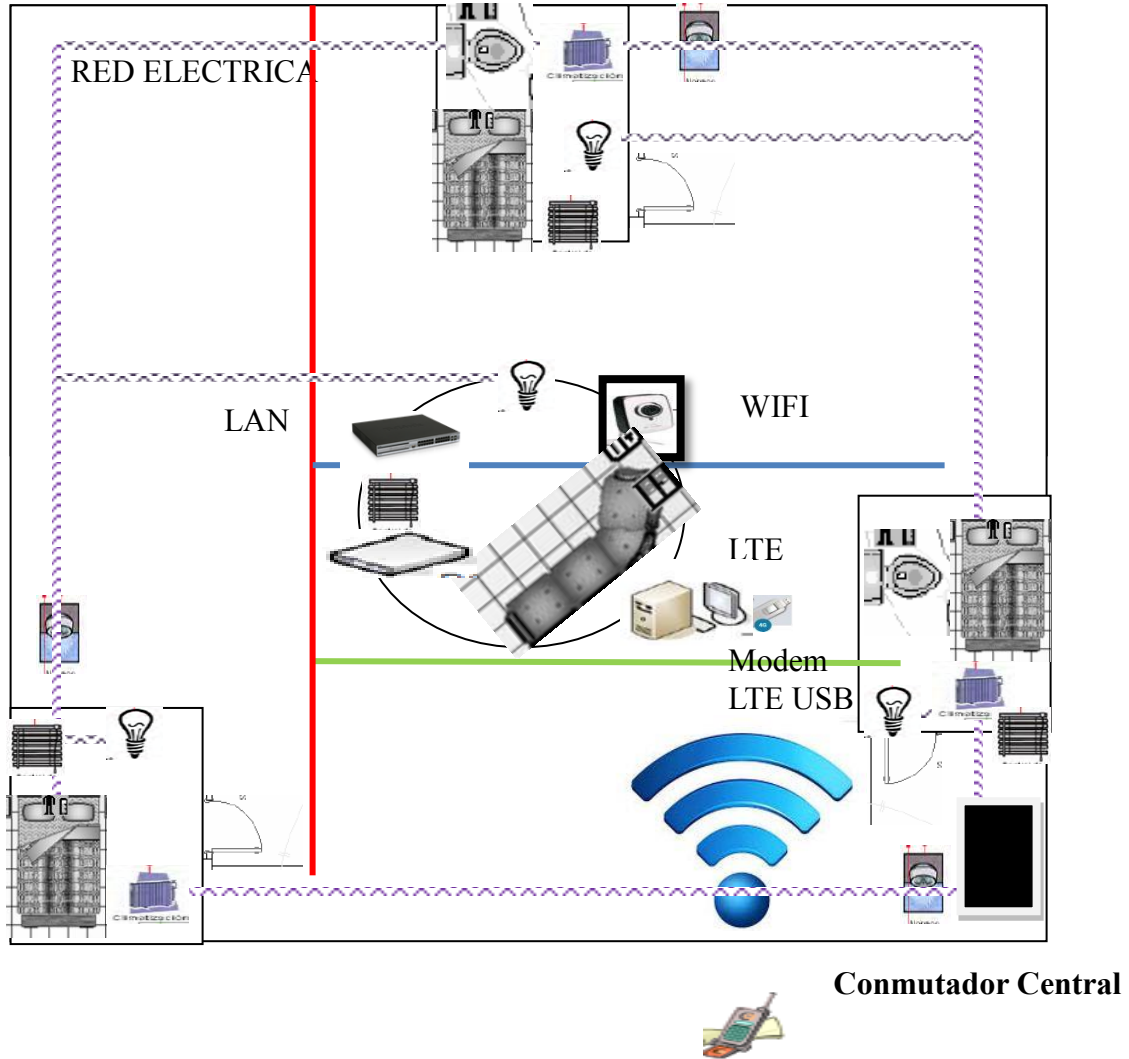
Instalación de la Red Domótica y Red Eléctrica en la Planta Alta de la Vivienda
